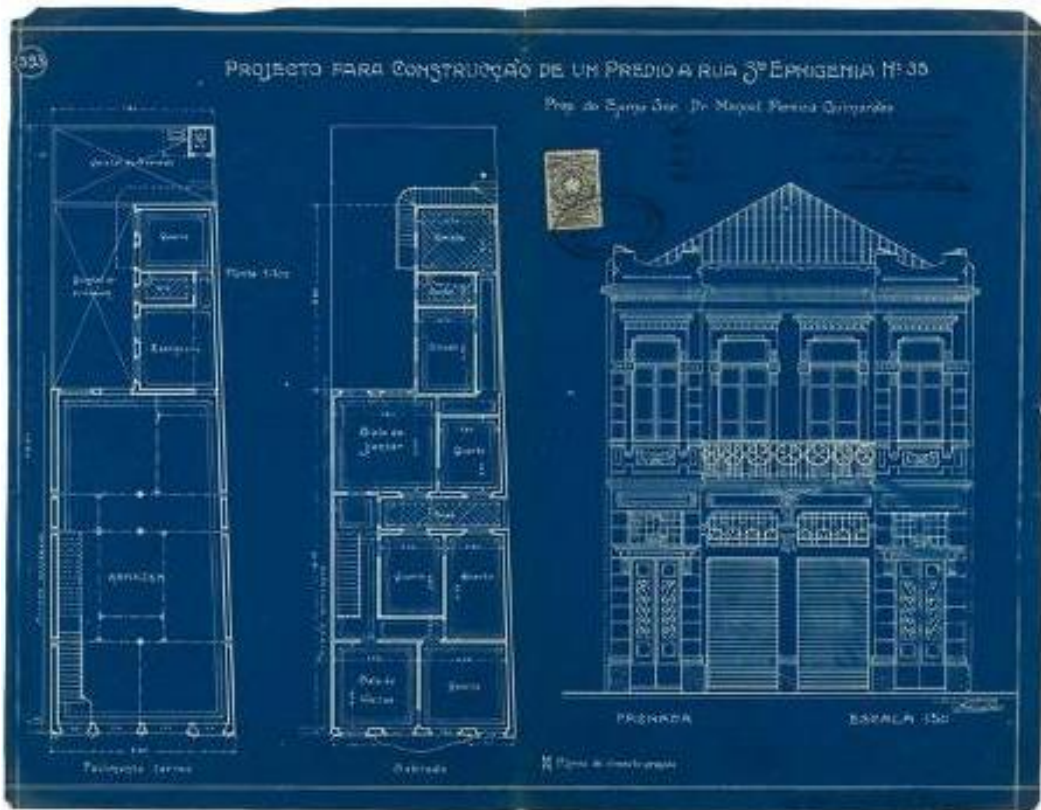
Elevação e plantas térreo e primeira de sobrado misto na rua Santa Ifigênia
